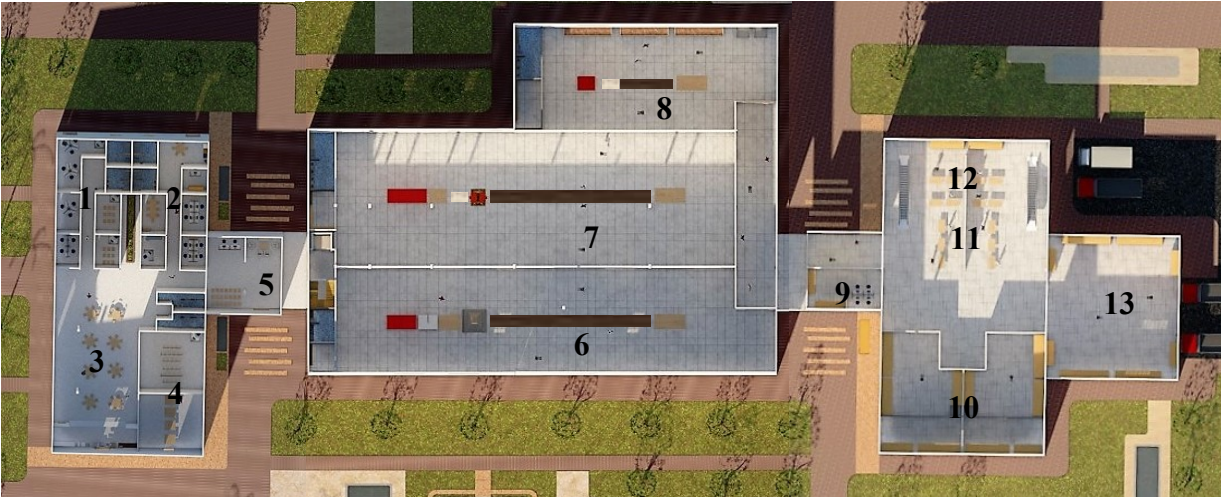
Implantación planta de tratamiento. Fuente: Elaboración propia.
